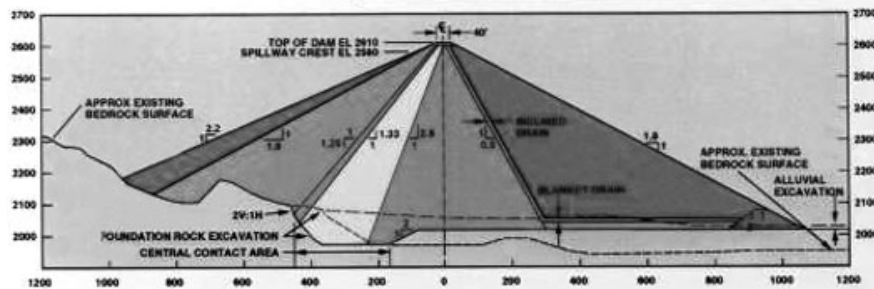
Seven Oaks ダム (標準断面図および洪水吐き断面図)
